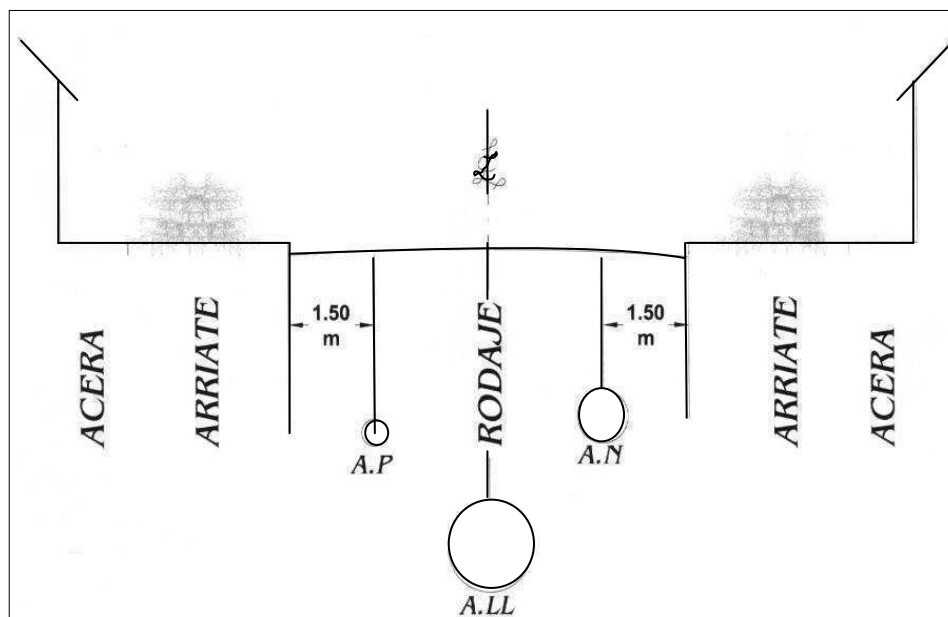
Detalle típico de ubicación de tuberías en un derecho de vía.
